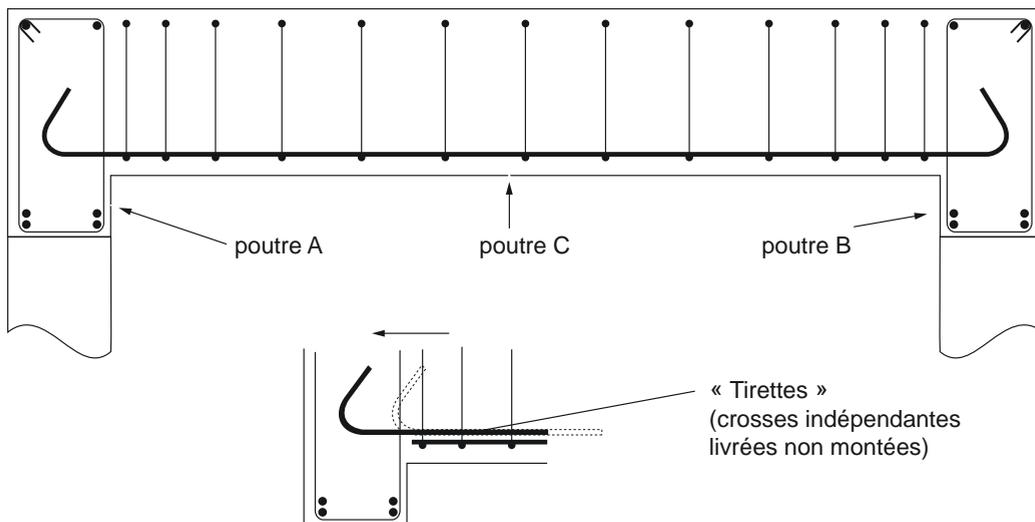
appui d'une poutre sur une autre poutre, incidence sur la position des armatures.
